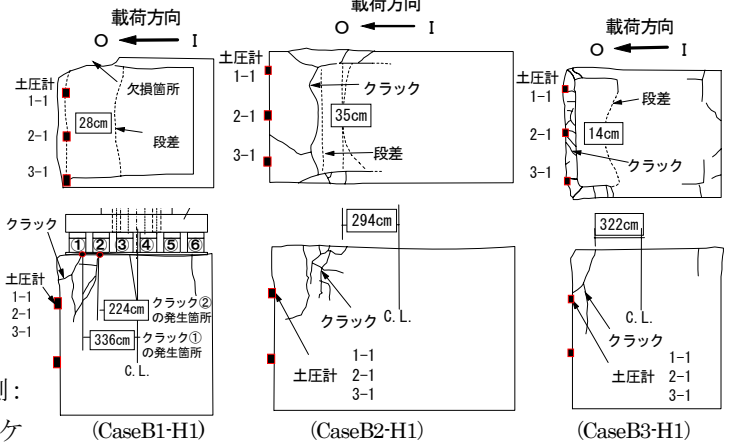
固化体の損傷状況 (上: 平面図, 下: 側面図)
